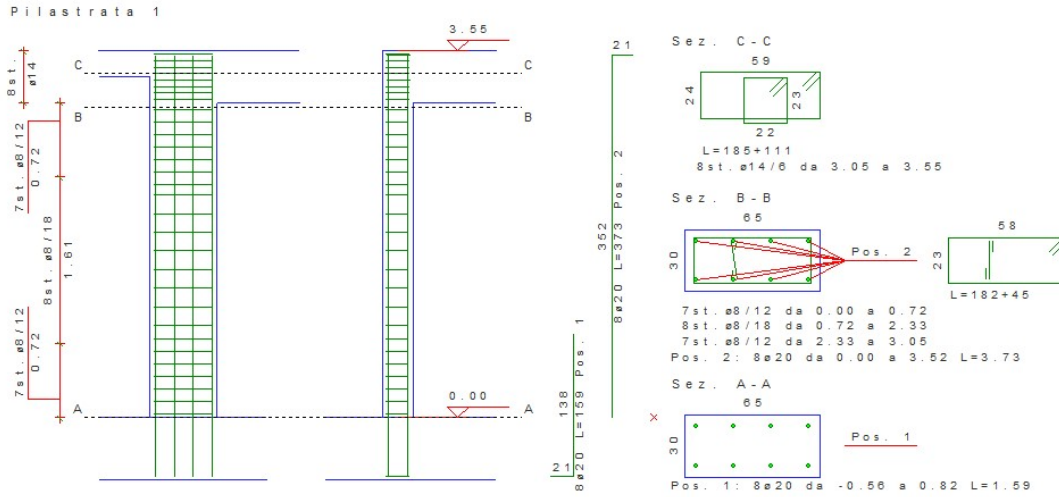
PILASTRO N. 1, 6, 7, 12
